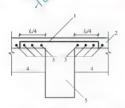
垂直于主梁的板面附加配筋 1一垂直于上梁的构造钢筋; 2一板; 3一板内纵向钢筋; 4一次梁; 5一上梁
